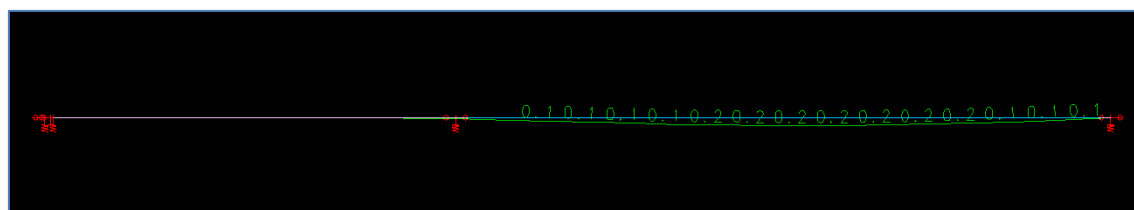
Deslocamentos verticais V16 do 2º pavimento, concreto armado (CAD/TQS).
